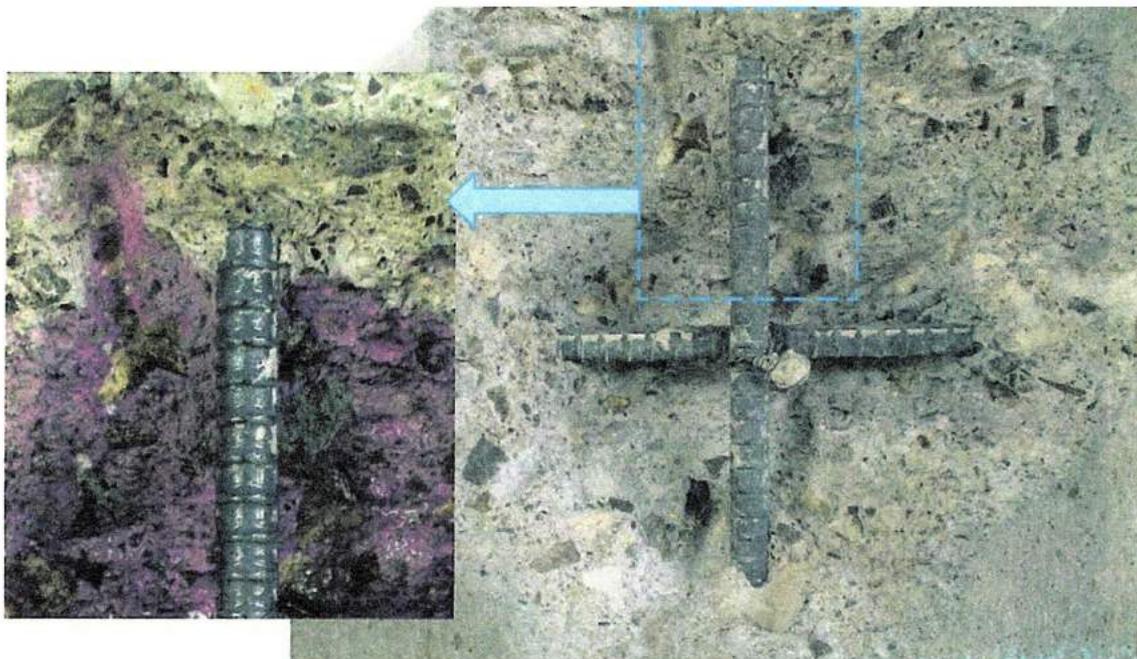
調査点C(屋内, ひび割れ無し)の鉄筋の状況と中性化深さ調査の状況
